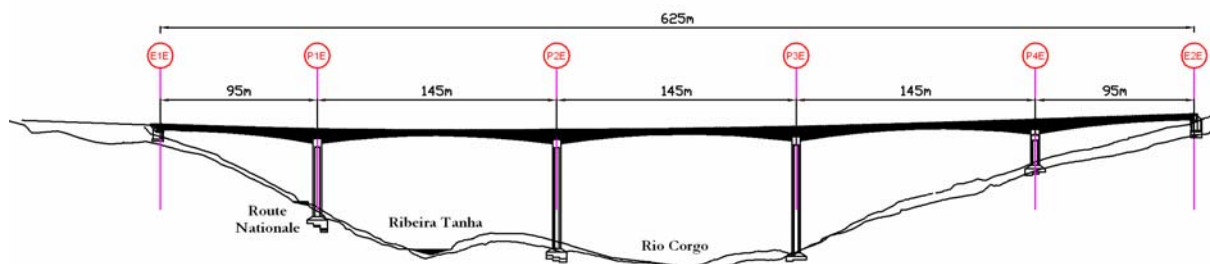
Vue en élévation du tablier intérieur / Elevation of inner deck
